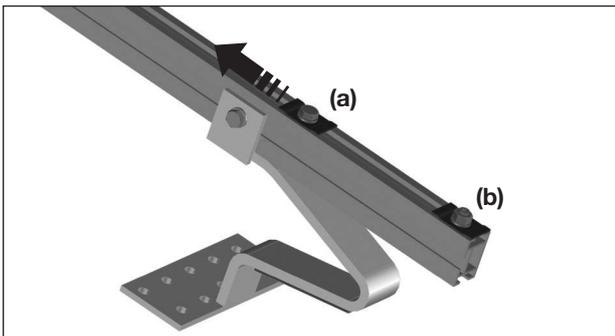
Déplacer la plaque de serrage (a) vers «le haut»
